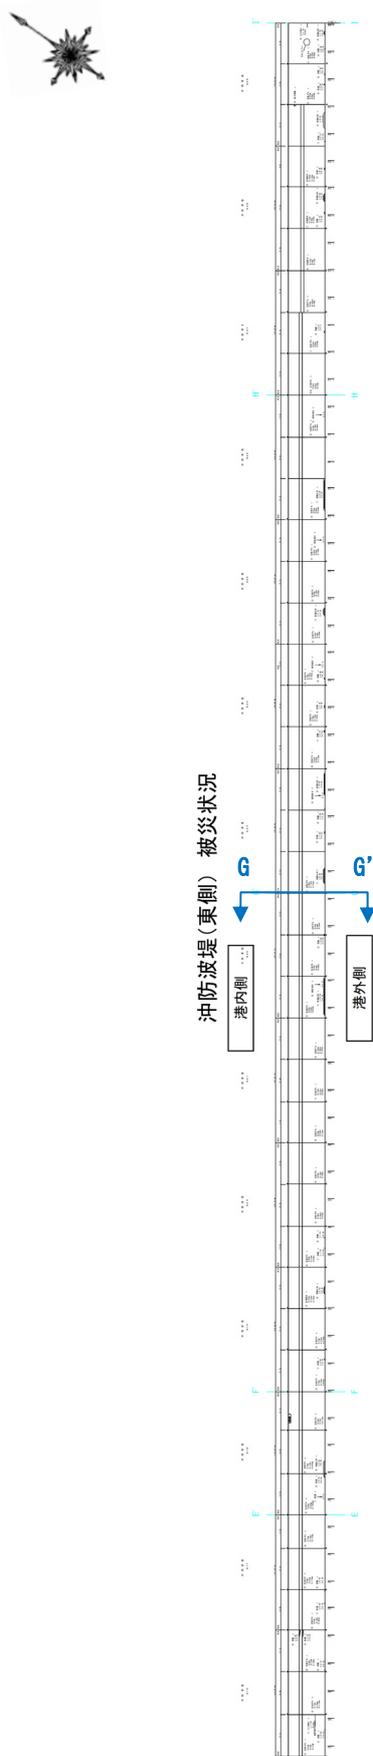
仙台港区\_外港地区\_沖防波堤の平面図(東側) (被災後)
